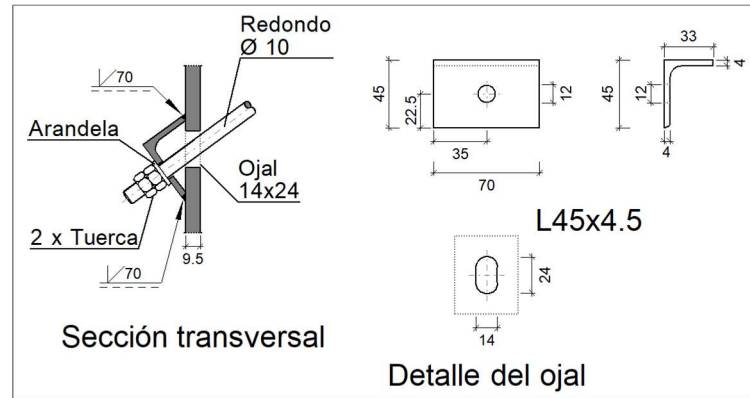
Geometría unión tipo 5 (redondo a pilar)
